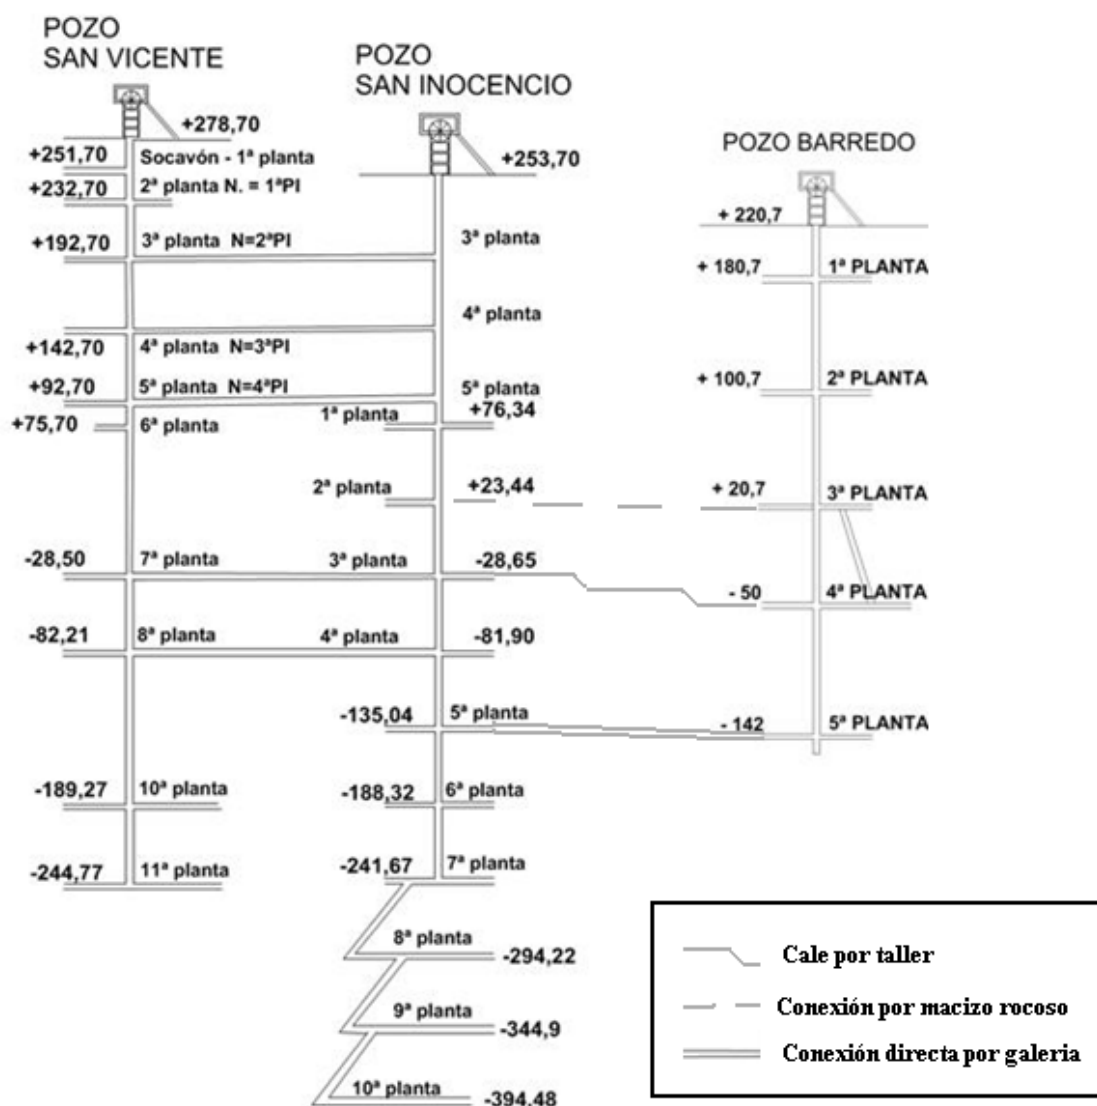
Esquema de las plantas de los pozos San Vicente y San Inocencio (Figaredo) y Barredo.
